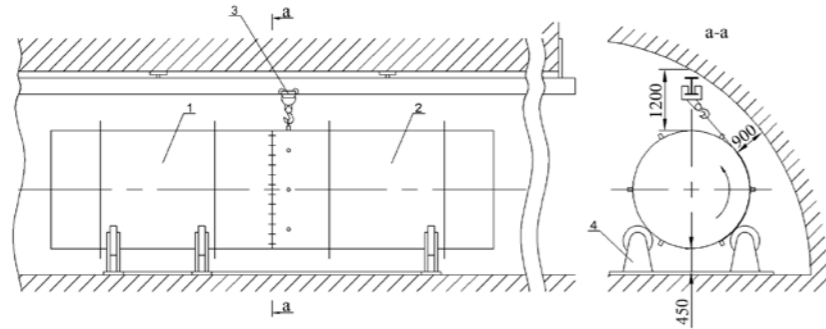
Схема прокрутки укрупненной марки водовода на рольганге
